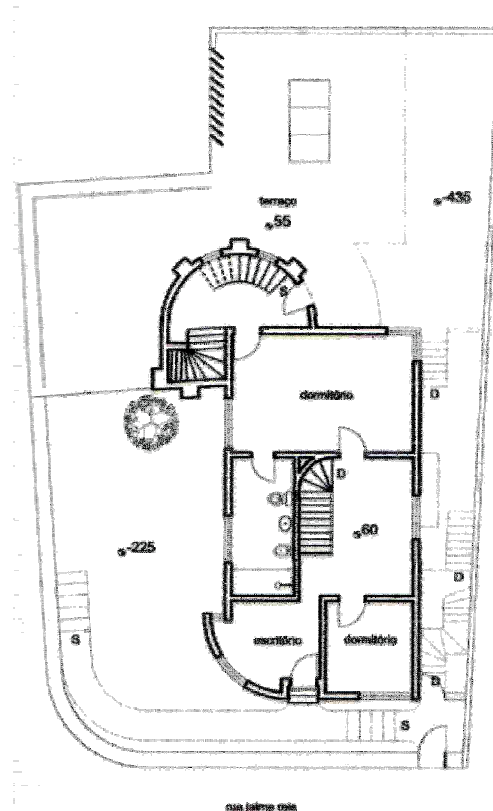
PLANTA DO SEGUNDO PAVIMENTO
